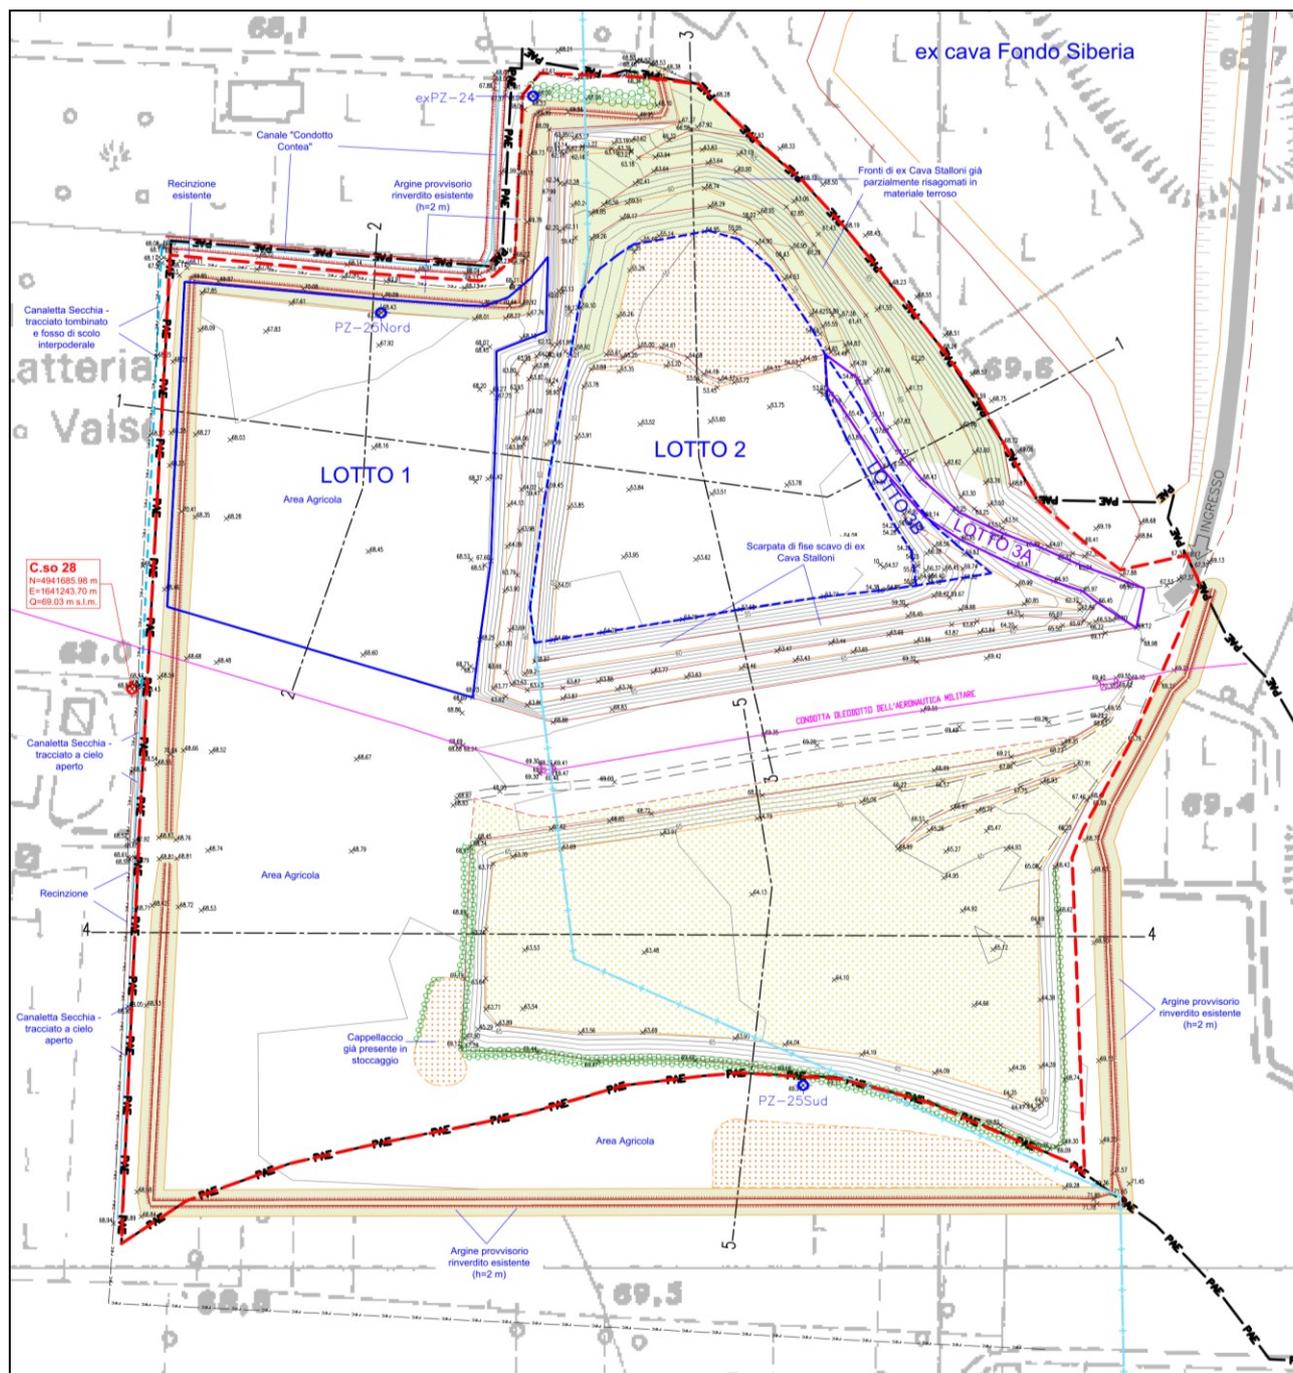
Estratto da tavola 02 del progetto "Planimetria dello stato di fatto"
